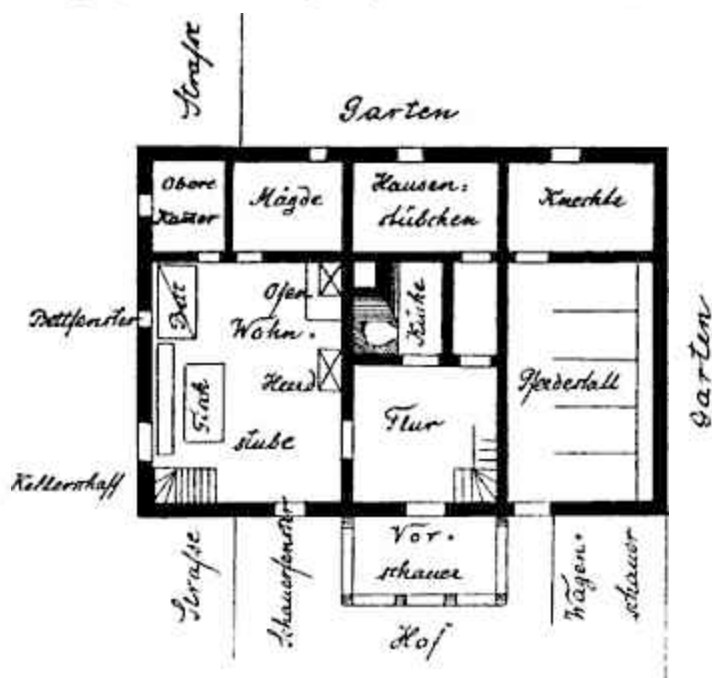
Grundriss des ermländischen Bauernhauses.
